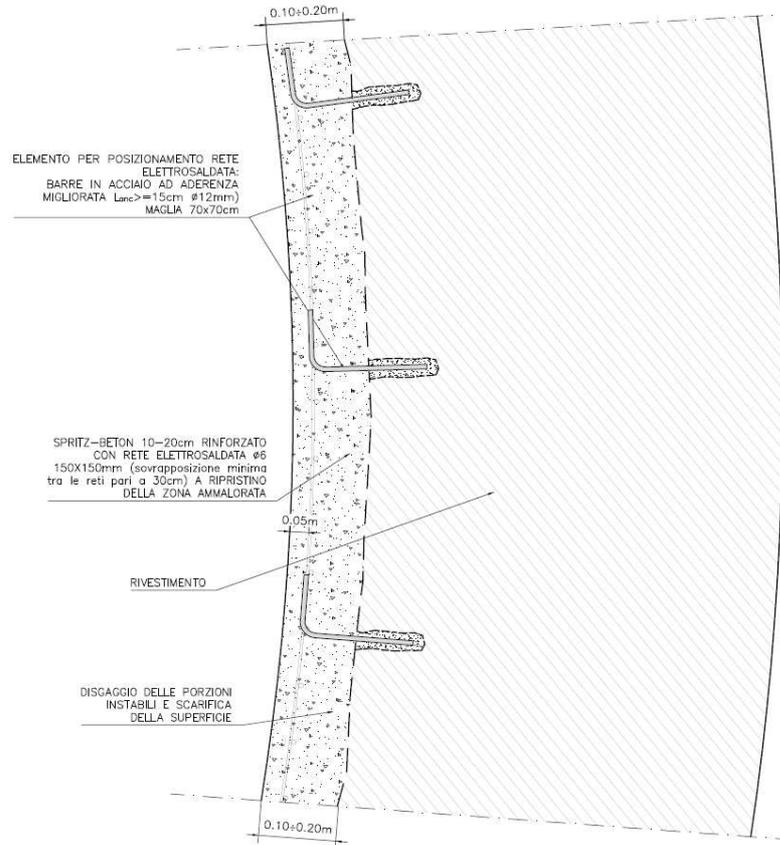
Dettaglio ripristino piedritti in calcestruzzo non armato
